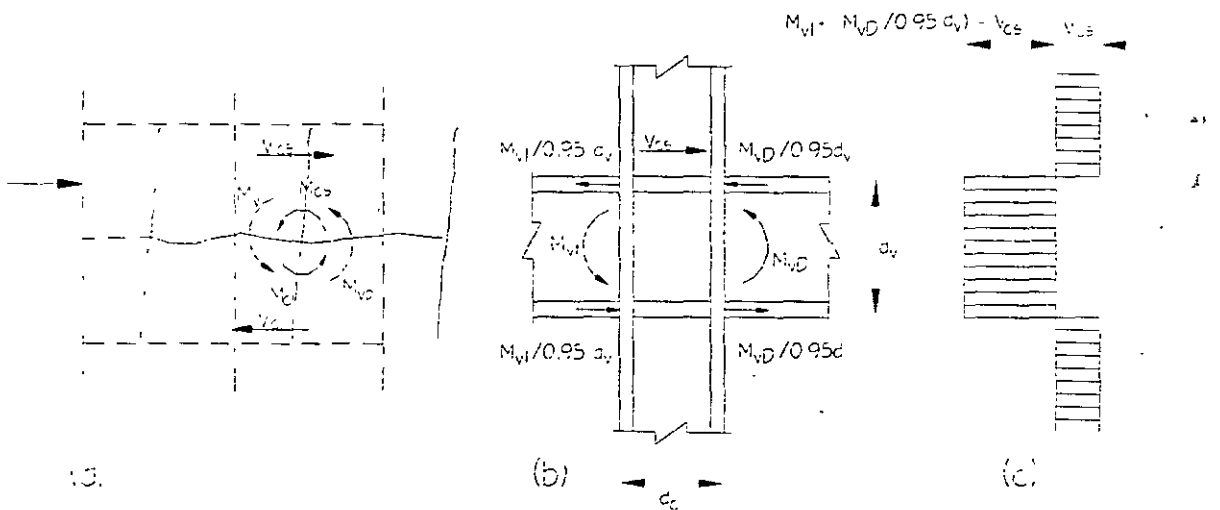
Junta de un marco rígido en el que obran cargas Verticales y horizontales
